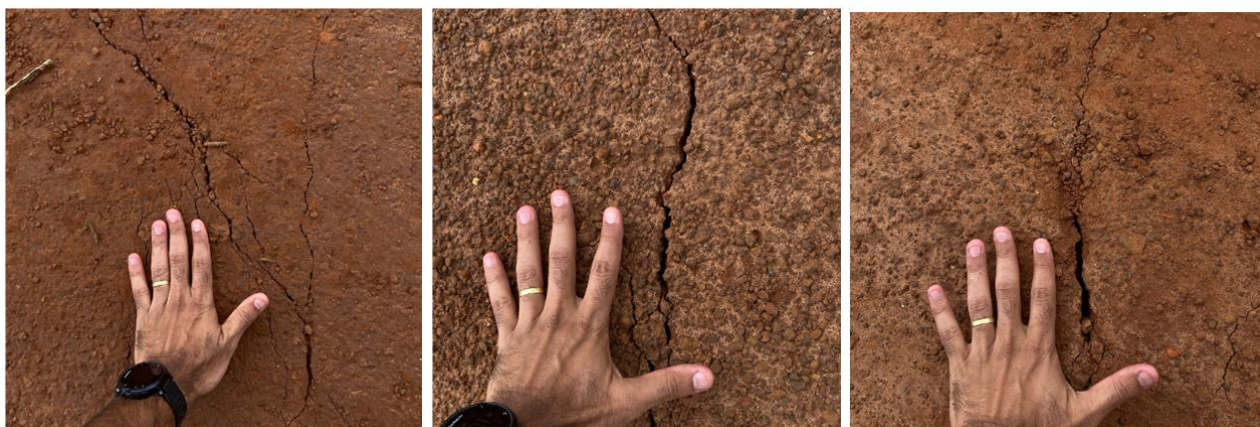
Rachaduras apresentadas sobre o aterro da superestrutura da ponte.
